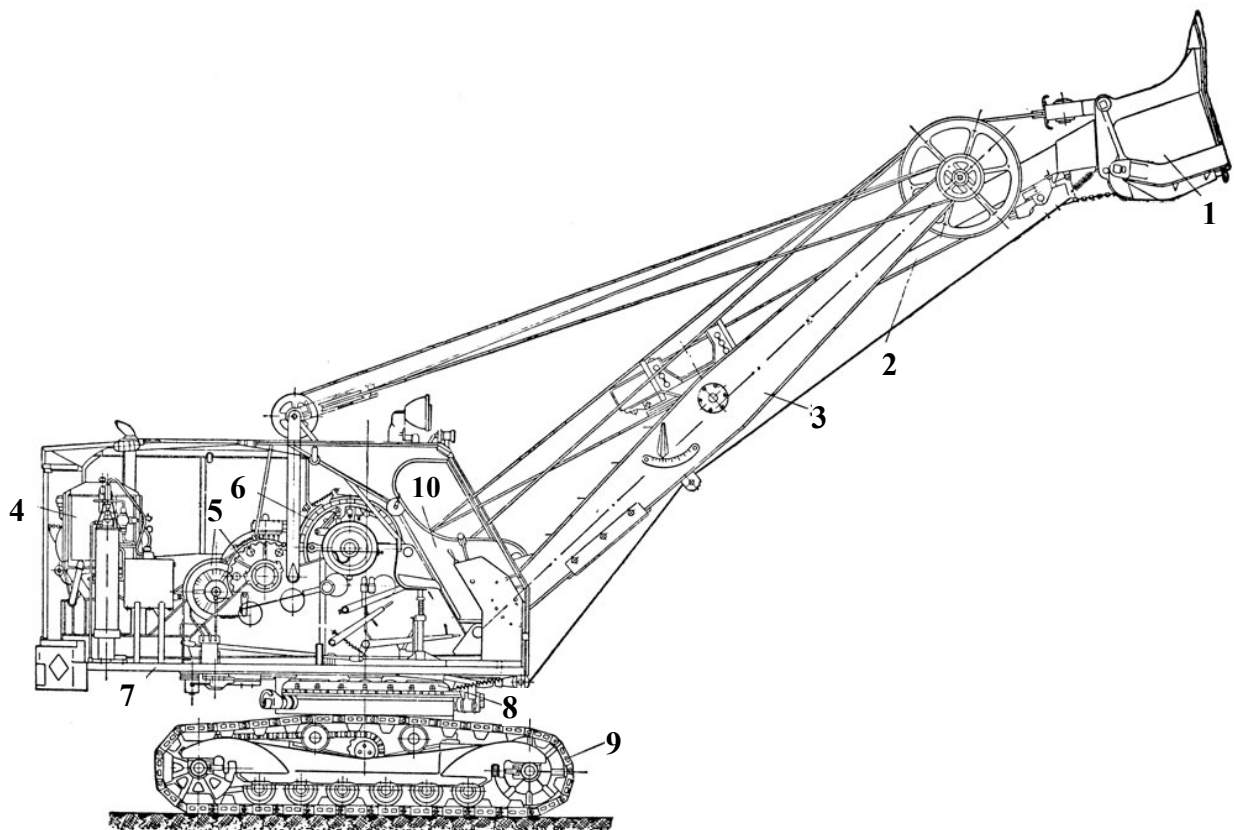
Гусеничний екскаватор з обладнанням «пряма лопата»: 1 – ківш; 2 – держак; 3 – стріла; 4 – двигун; 5 – передавальні механізми; 6 – головна лебідка; 7 – поворотна платформа; 8 – поворотний механізм; 9 – гусеничний хід; 10 – кабіна машиніста-екскаваторника
